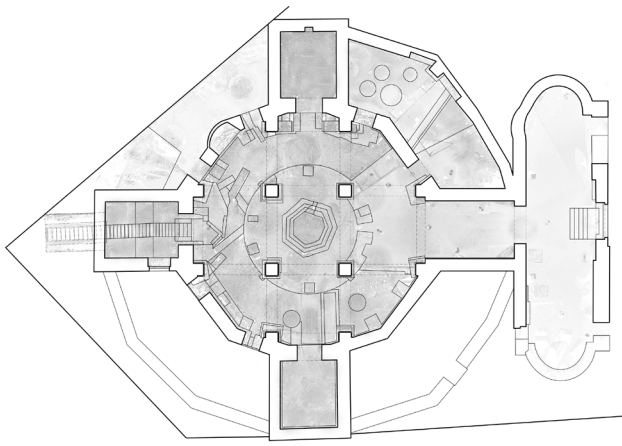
Sovrapposizione del disegno vettoriale della planimetria del battistero di San Giovanni a Canosa di Puglia all'ortofotopiano elaborato con il software Faro Scene.
